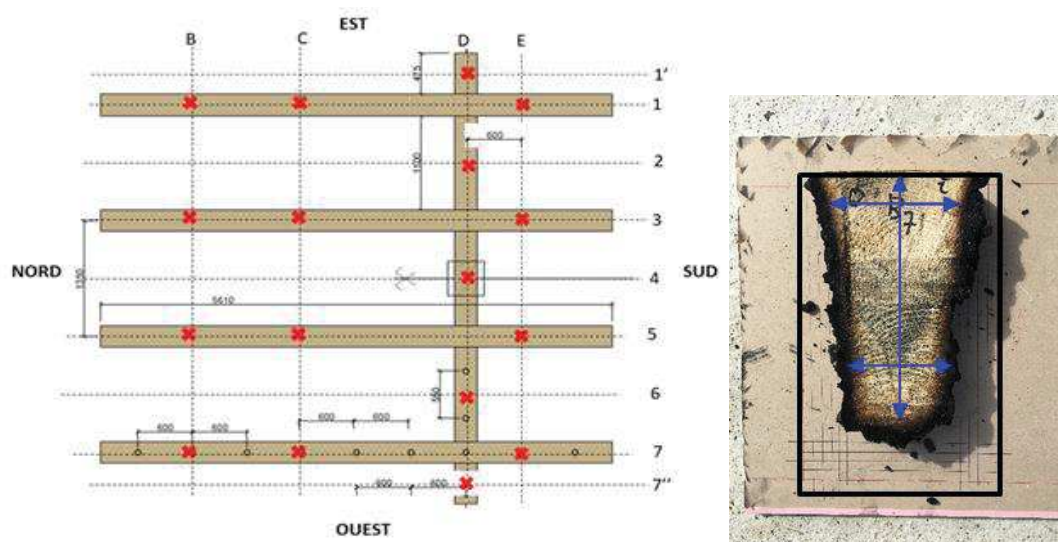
Position des prélèvements (tranche) des solives et des entretoises et localisation des mesures sur une coupe type de poutre (le contour noir représente la section initiale de la poutre)
